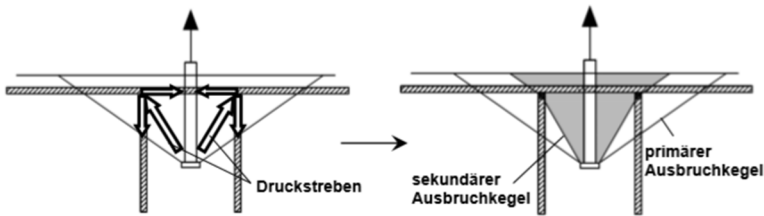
Krafteinleitung in eine Verankerung mit Rückhängebewehrung (links) und Bruchkegel beim Betonversagen (rechts) nach [125]
